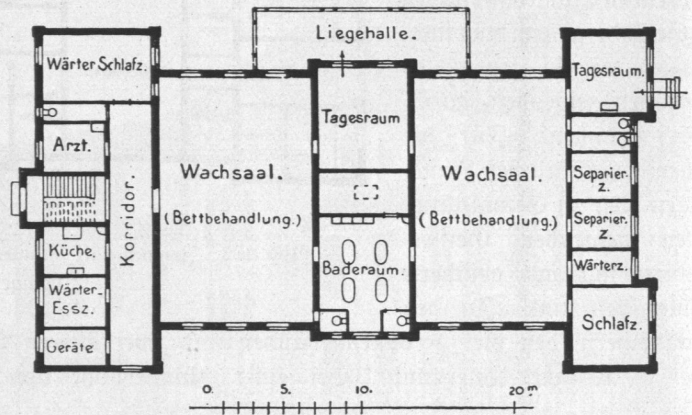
Irrenanstalt Langenhorn, Krankengebäude für Kranke und Gelähmte, Erdgeschoss, Grundriß.
